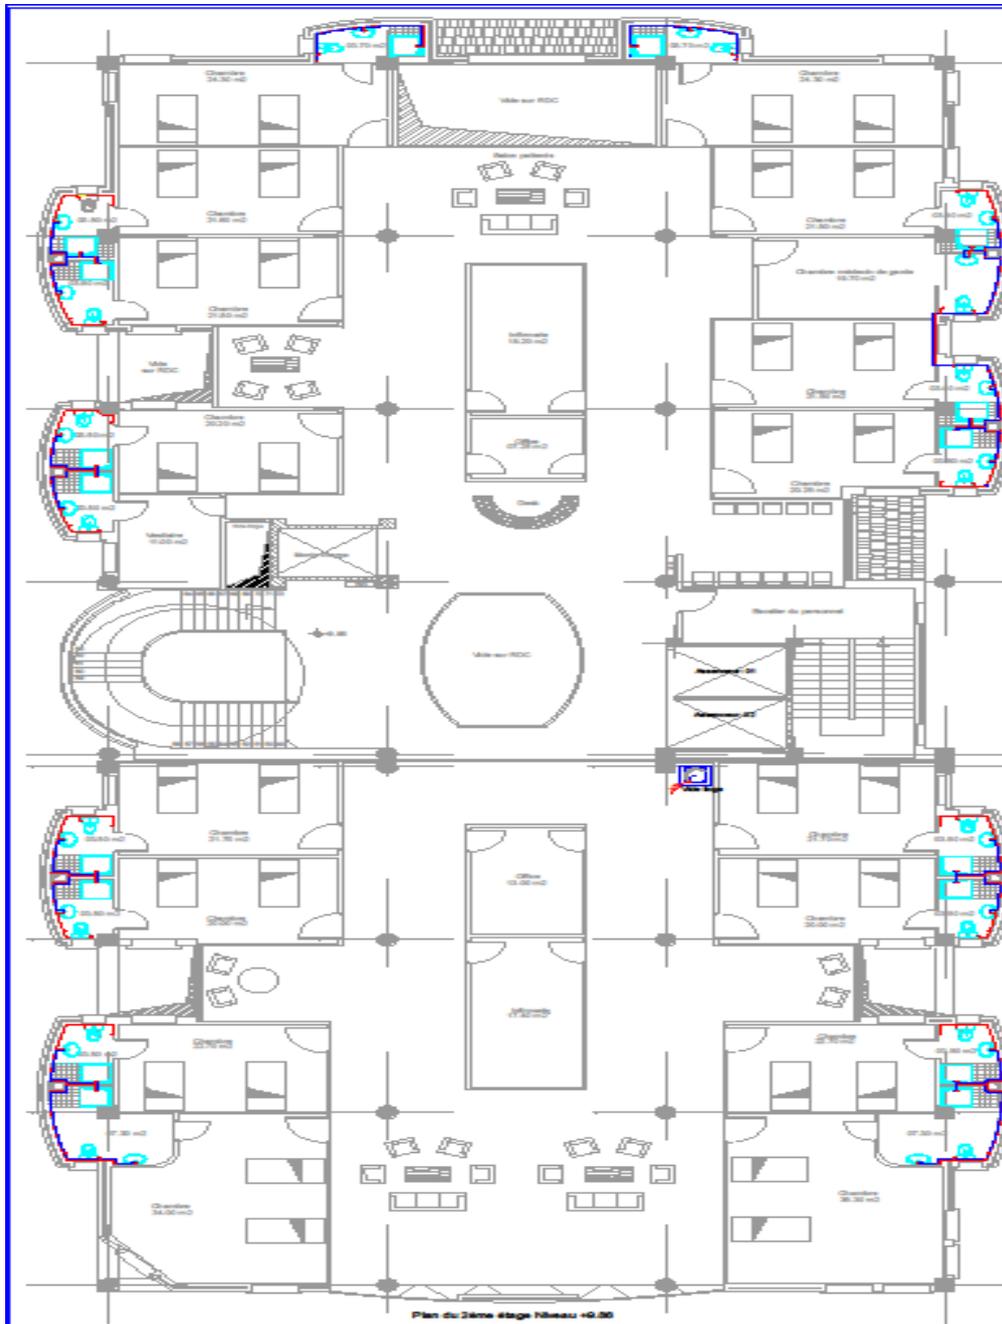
Plan Étage 2 de la clinique du Rameau Olivier
